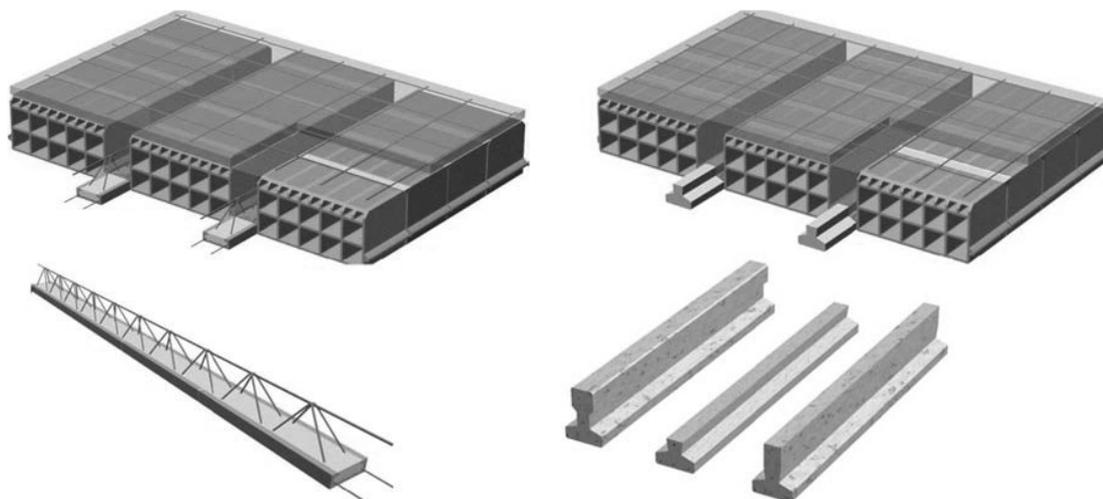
A sx un solaio con travetti prefabbricati in c.a. a traliccio (sotto il dettaglio con struttura reticolare spaziale); a dx, invece, schema di un solaio con travetti prefabbricati in cemento armato precompresso (sotto il dettaglio del travetto). Tratte da Paolacci F. Sgueri L., *Progetto di strutture in c.a.. Il solaio: tipologie e modellazione*, Università degli Studi Roma Tre, Facoltà di Architettura
